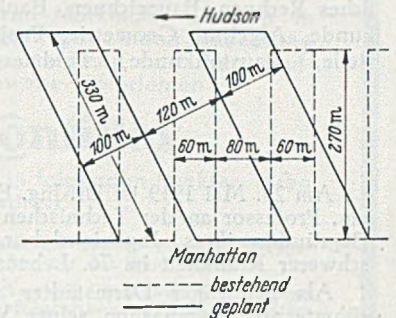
Entwurf zur Verbesserung der Pieranlagen.
